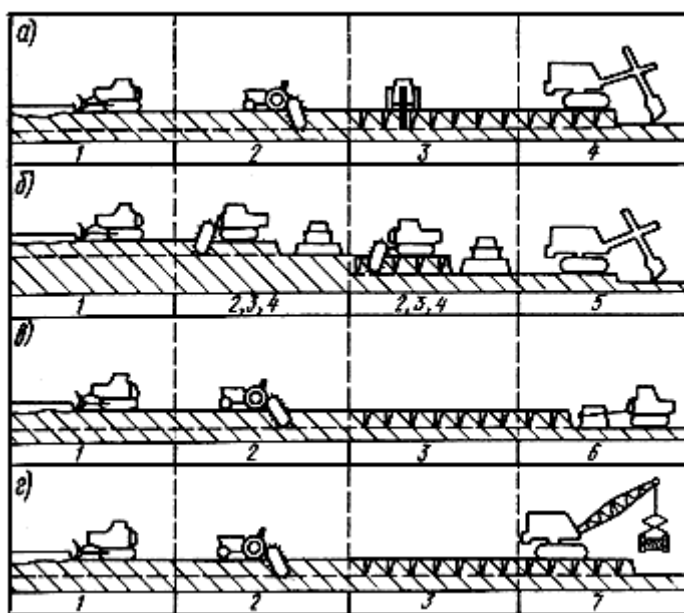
Схемы разработки мерзлых грунтов блочным способом: а, б - мелкоблочным способом; в, г - крупноблочным; 1 - удаление снежного покрова; 2, 3 - нарезка блоков мерзлого грунта баровой машиной; 4 - разработка мелких блоков экскаватором или бульдозером; 5 - разработка талого грунта; 6 - разработка крупных блоков мерзлого грунта трактором; 7 - то же, краном.
